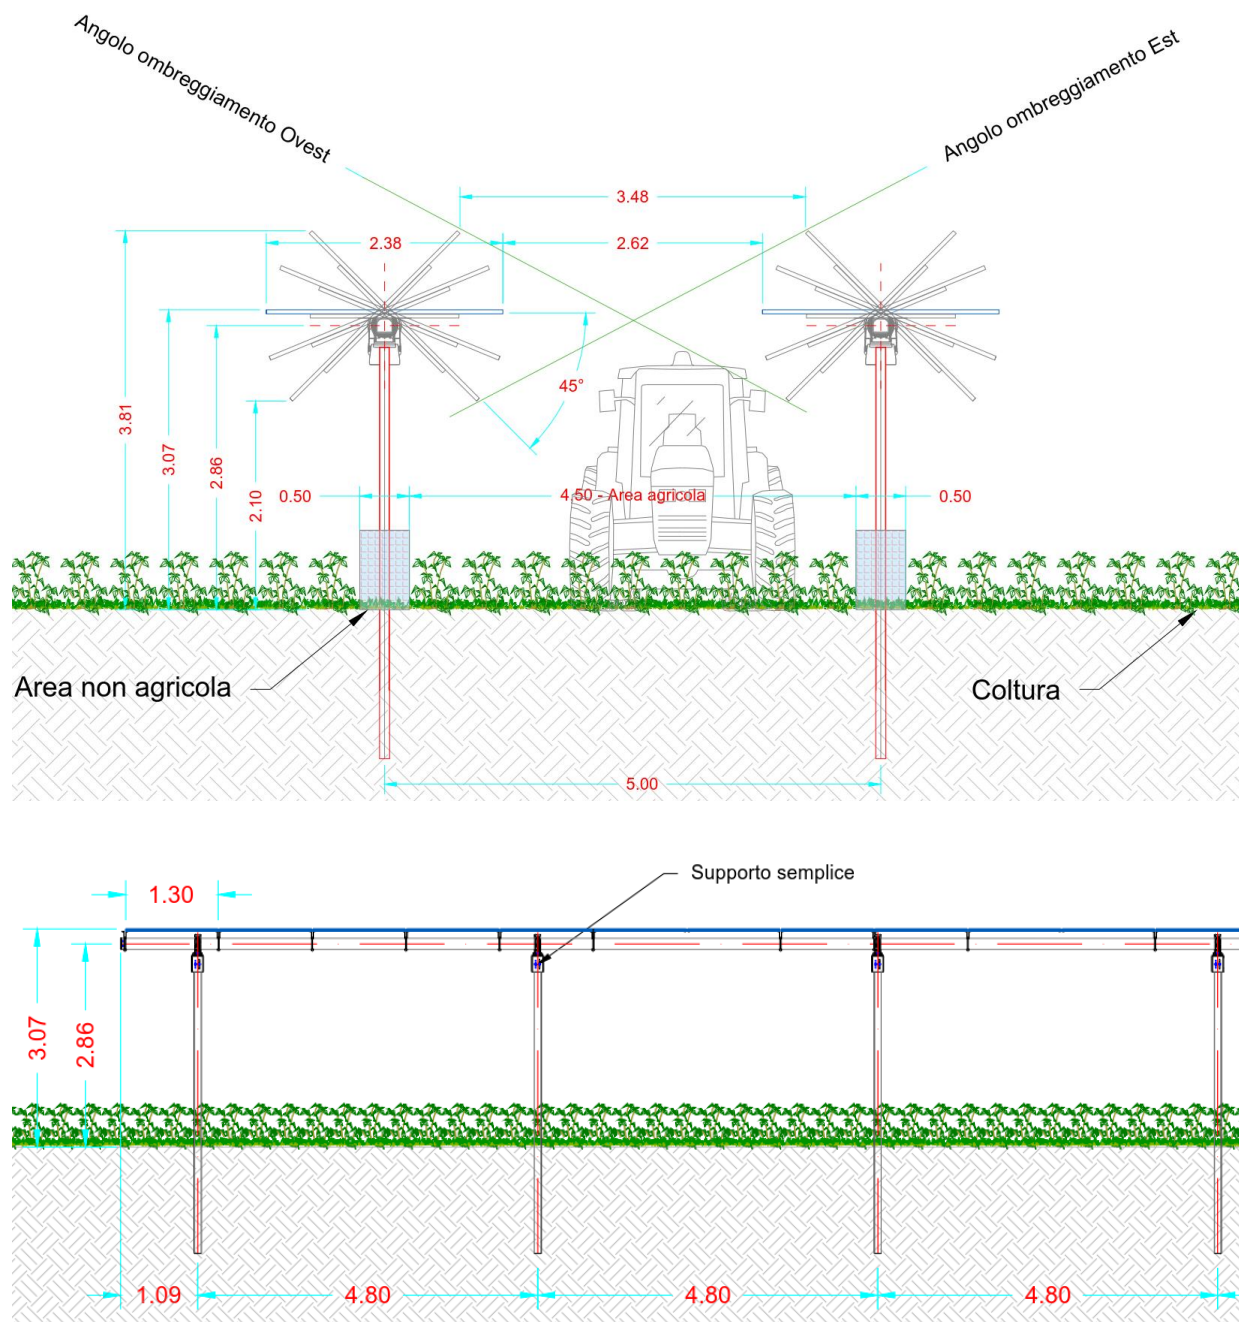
Sezione trasversale e longitudinale tipologica struttura Tracker – Area 05
